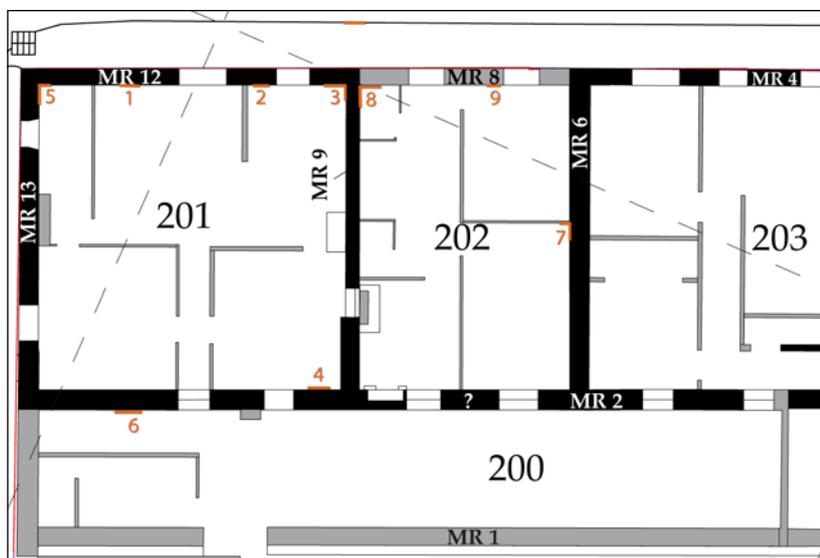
Plan de localisation des faits de l'espace 202 (DAO M. Panneau, S. Ranchin)
